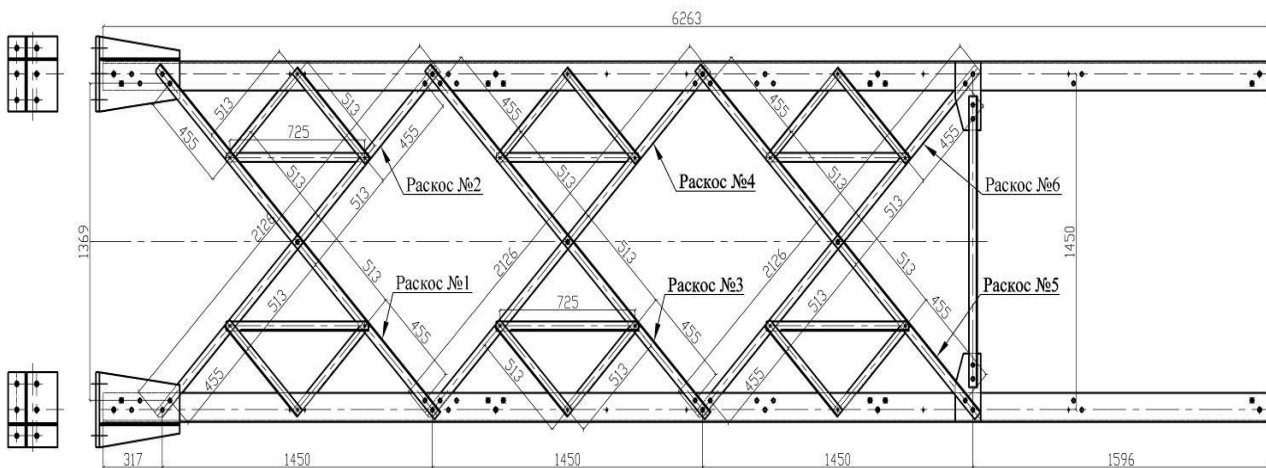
Монтажная схема испытуемой плоской фермы (раскосы из уголков L45x4)
